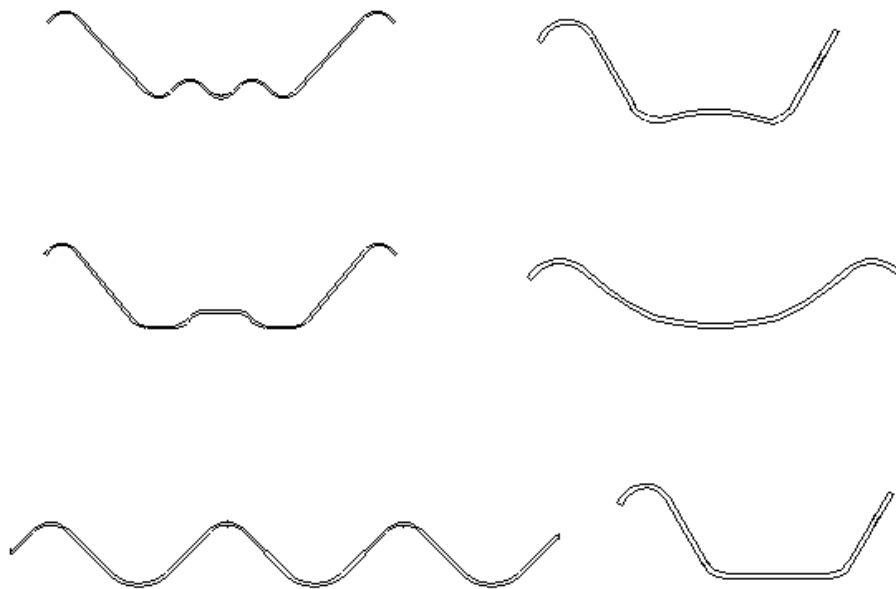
Exemplos de cortes transversais de perfis de telhas estruturais (Fonte: ABNT NBR 15210-1).
